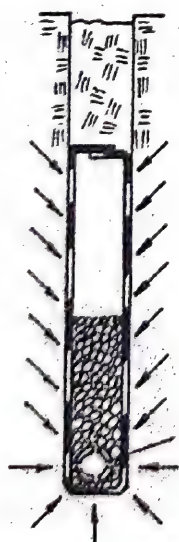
Dren îngust de asanare cu filtru geotextil si corp drenant de pietris
